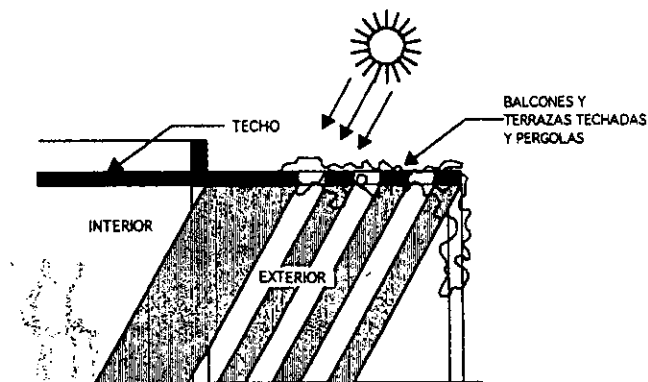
Uso de balcones y terrazas techadas y pergoladas
